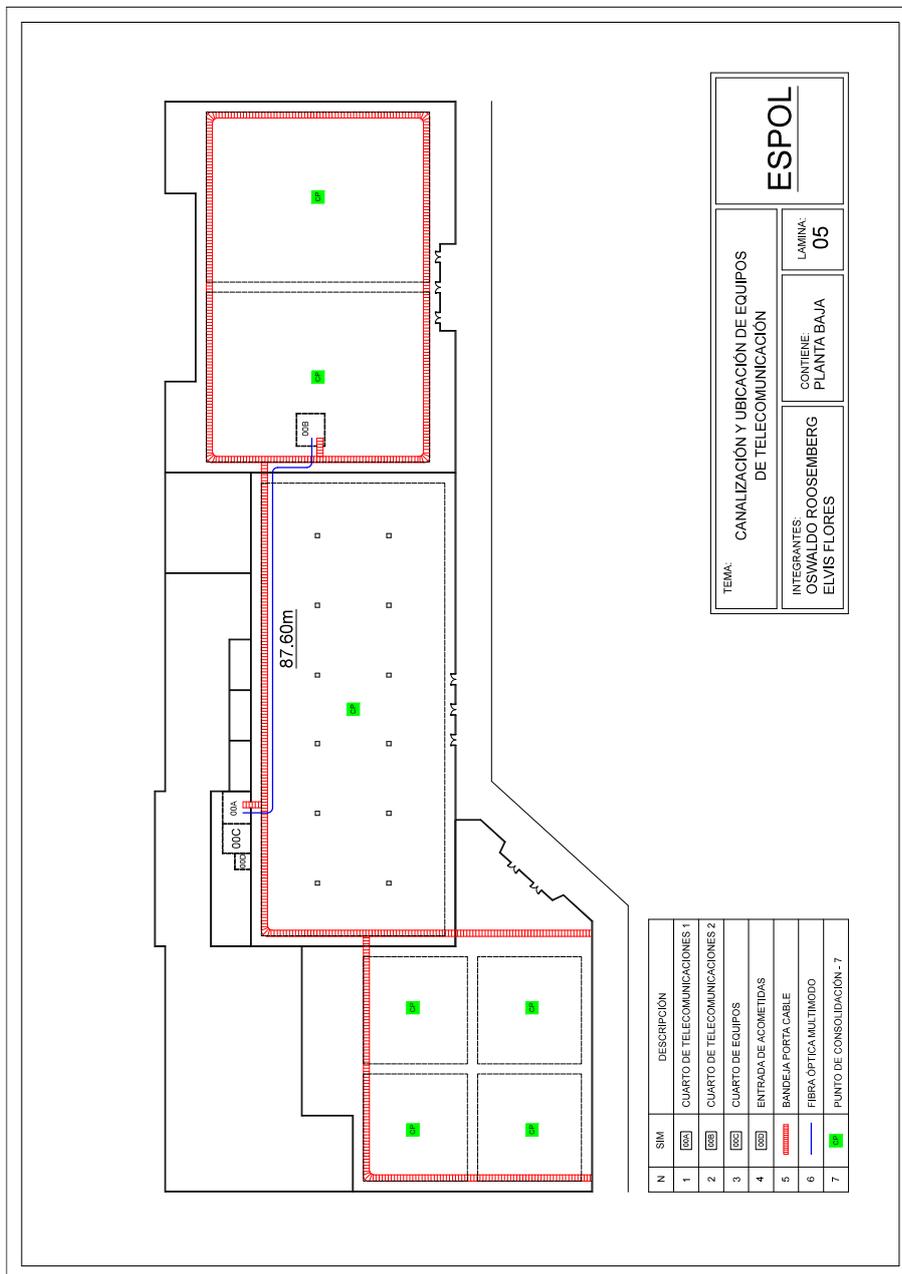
Plano de Canalización y Ubicación de Equipos de Telecomunicación – Planta Baja.
